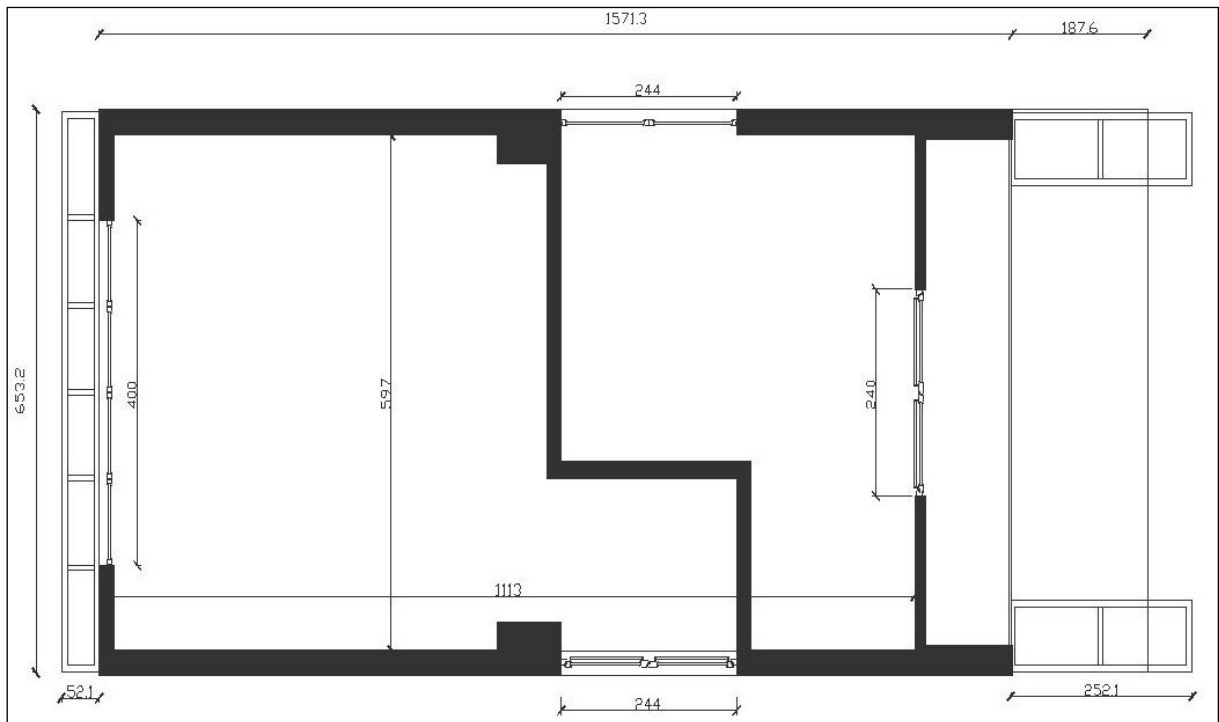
Planimetria riportante le quote principali (in cm), il muro di separazione e la posizione degli infissi.
